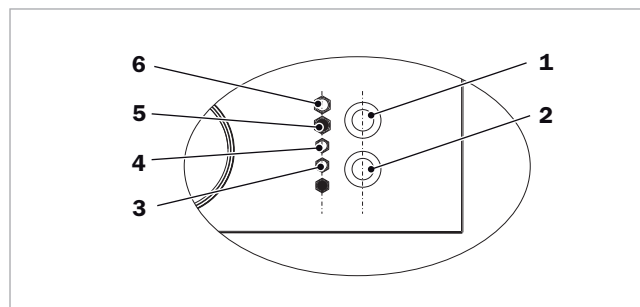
Anschlussdurchführung im Gehäusedeckel
